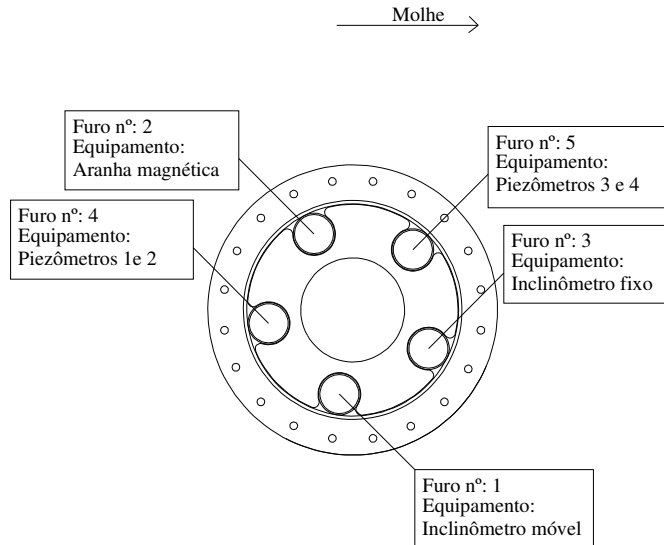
vista em planta da estrutura metálica tubular com o posicionamento dos equipamentos em uma estação de monitoramento
